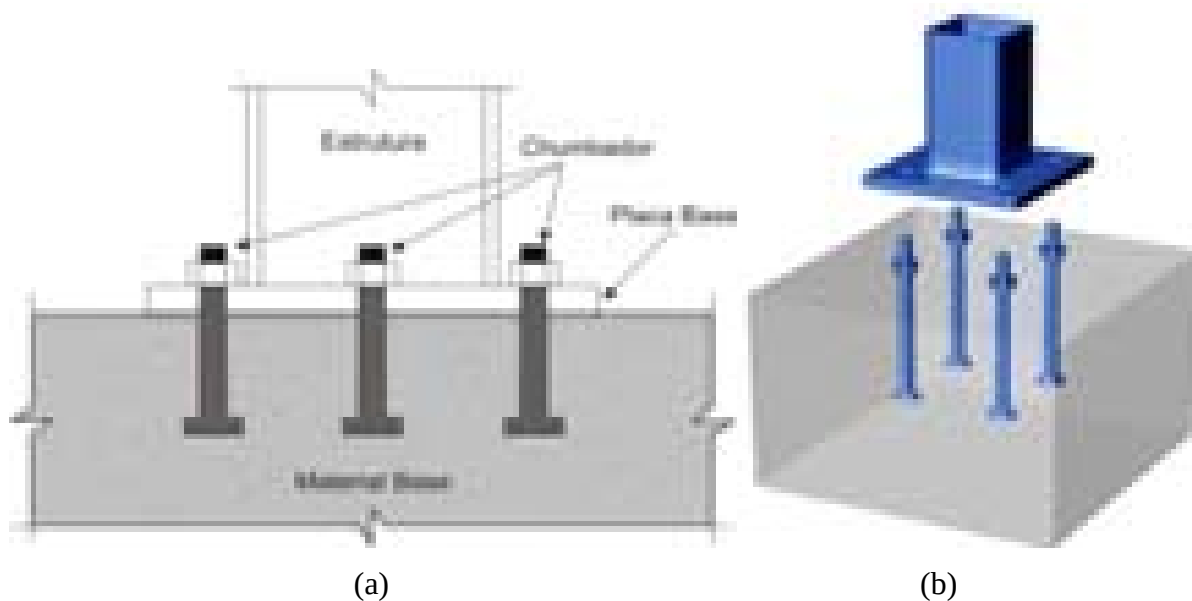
Sistema de ancoragem no concreto. a) Elementos componentes em uma ancoragem no concreto; b) Desenho esquemático em perspectiva.
